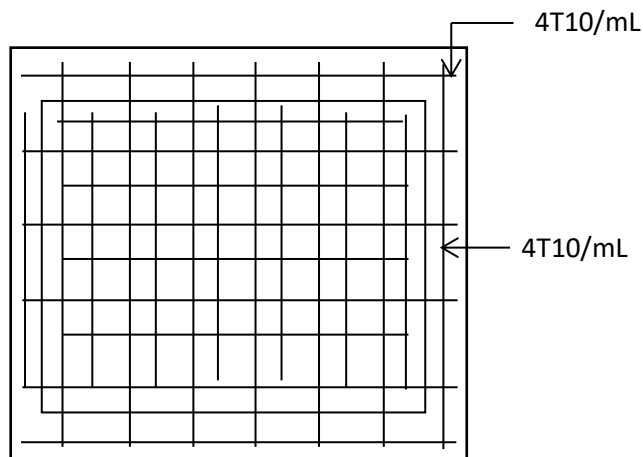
Ferrailage Inférieur du panneau de dalle
